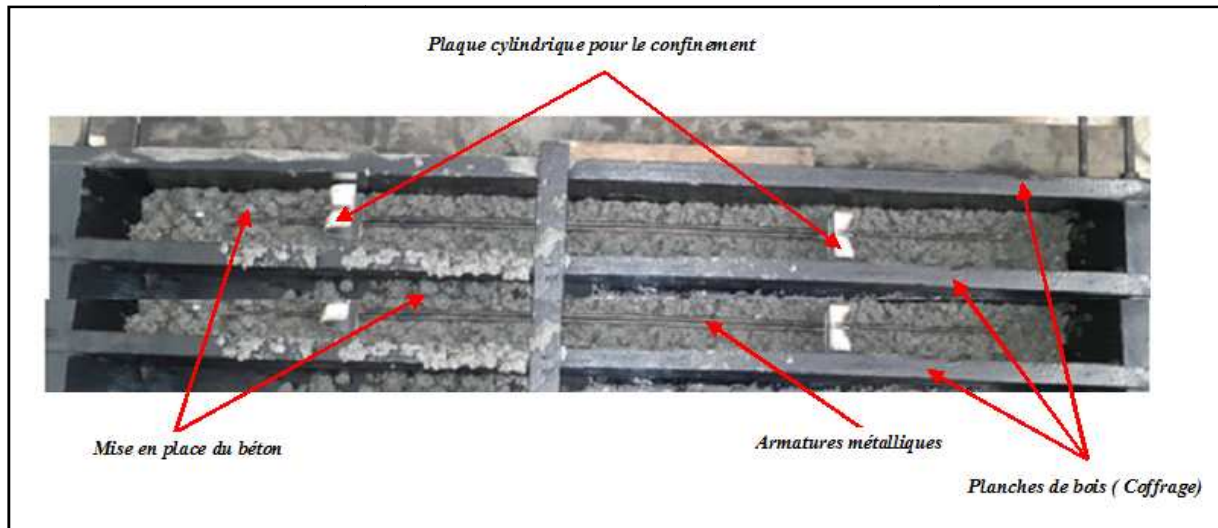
Vue du coffrage, bétonnage, disposition du ferrailage dans les poutres
